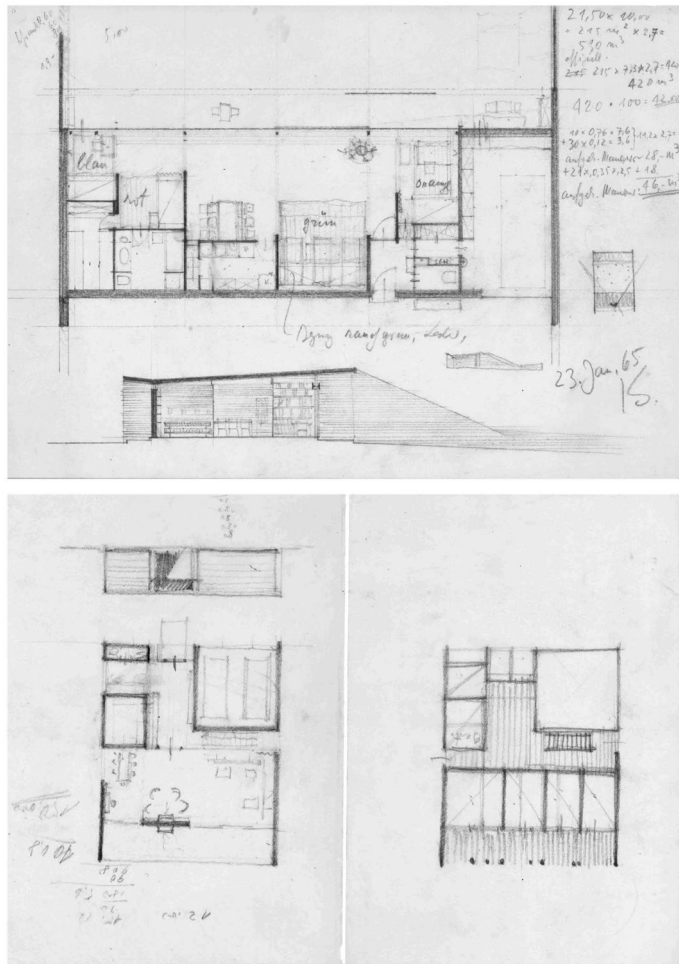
Josef Kaiser, Glas-Backstein-Haus, Grundrisse und Ansicht, 23.1.65.
